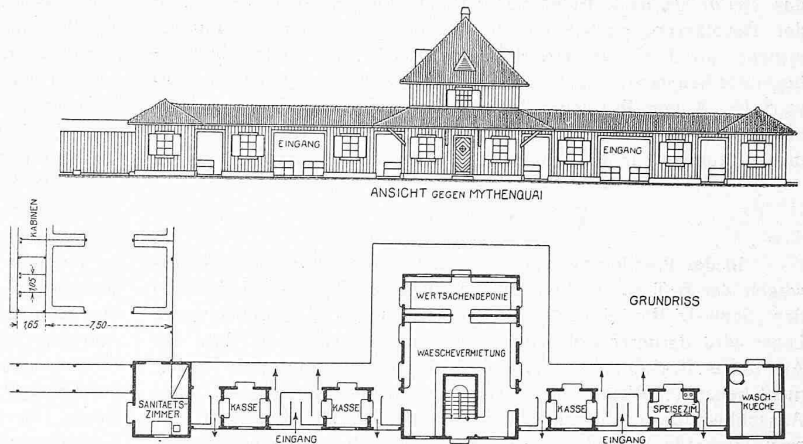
Eingangs-Gebäude des Zürcher Strandbades. — Grundriss und Ansicht 1 : 400.
